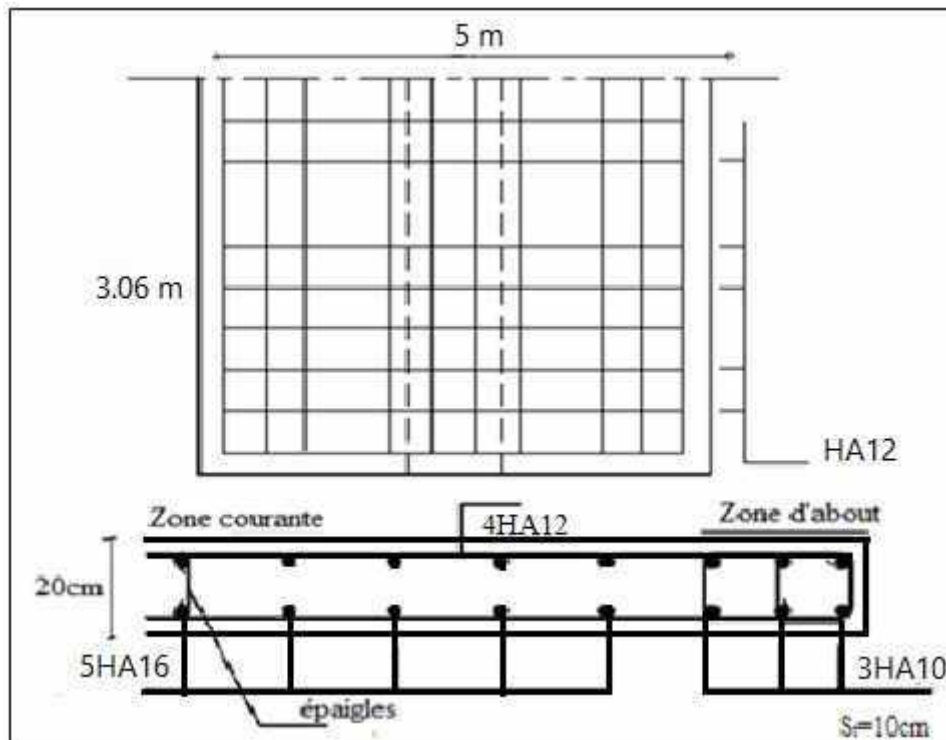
Schéma de ferrailage longitudinal et transversal de l'ensemble Poteau (RDC) et voile V1.
